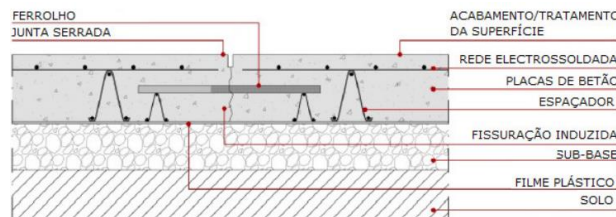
Pavimento de betão reforçado com o com malha eletrossoldada ⁷
